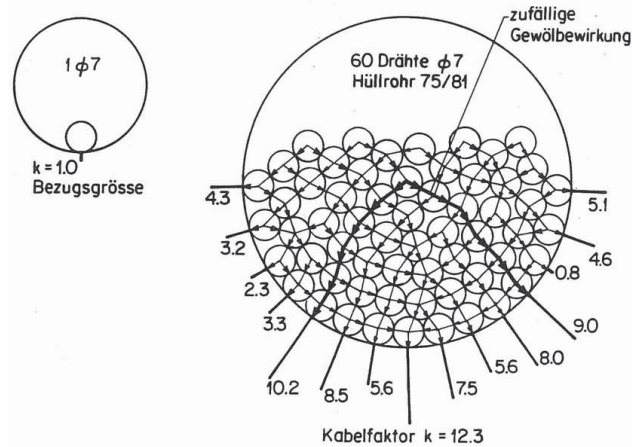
Querpressung für einen Einzeldraht und ein Paralleldrahtkabel mit 60 Drähten, aus [120]
